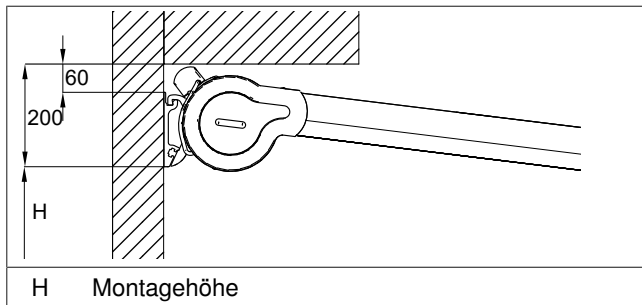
notwendiger Montageaum nach oben bei starrem Verstärkungsprofil (alle Maßangaben in mm)
